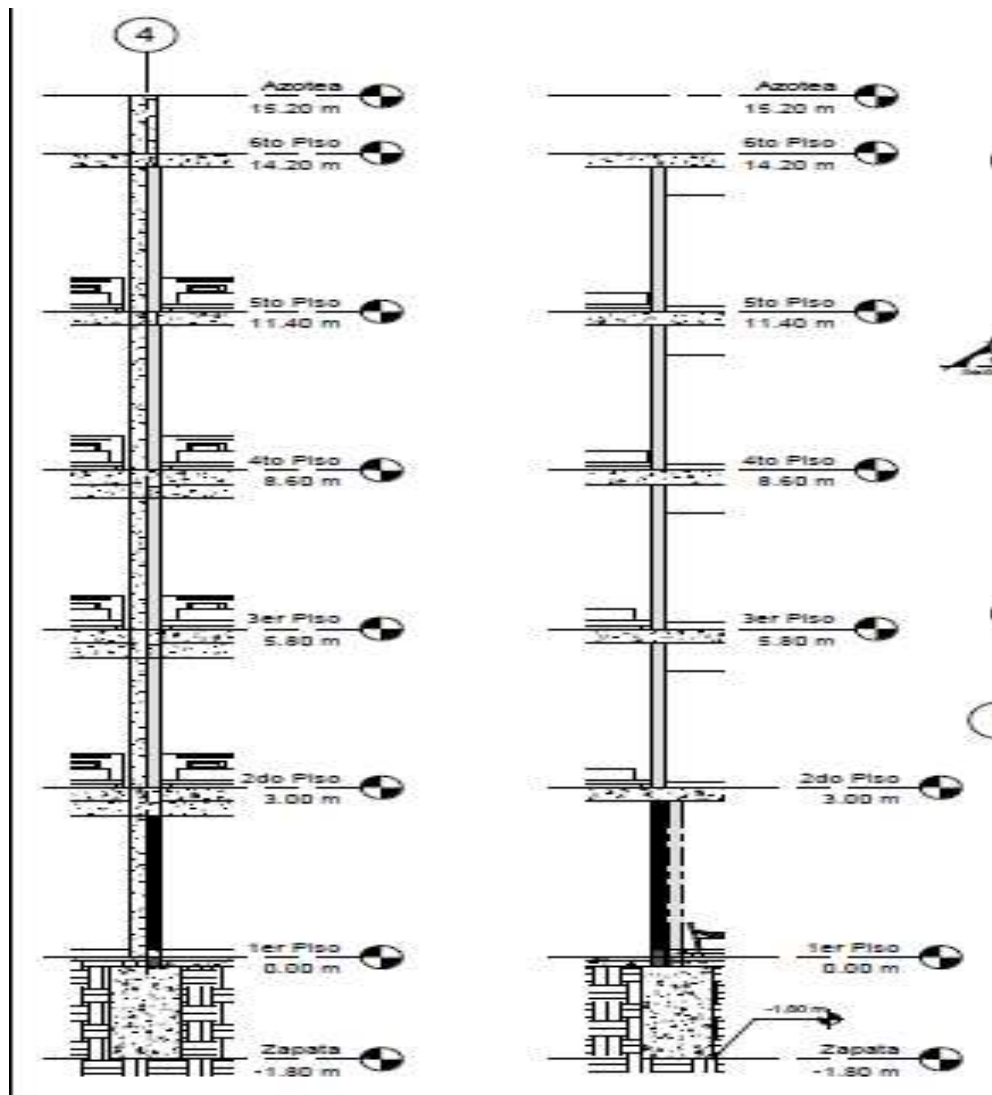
Corte de planta muros Adicional y de Soga Albañilería Reforzada Fuente Propia
